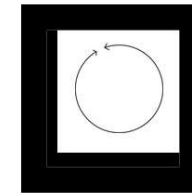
Planta esquemática. Edificio perimetral entorno a un espacio central
